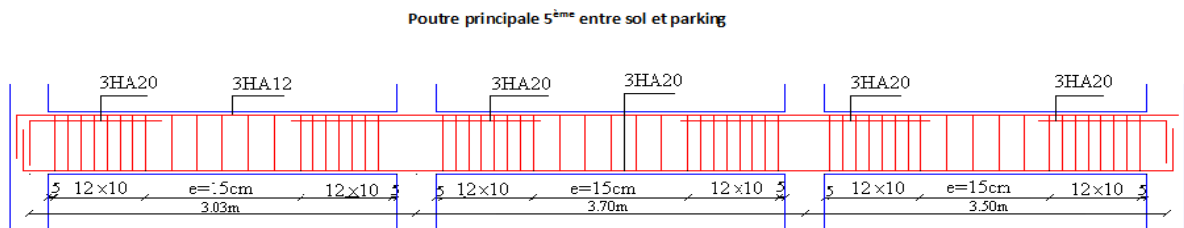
schémas du ferrailage d'une poutre principale du sous sol et parking
